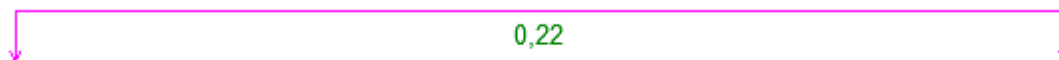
Нагрузка от перекрытия  $\gamma_f=1,3$ , т/м
